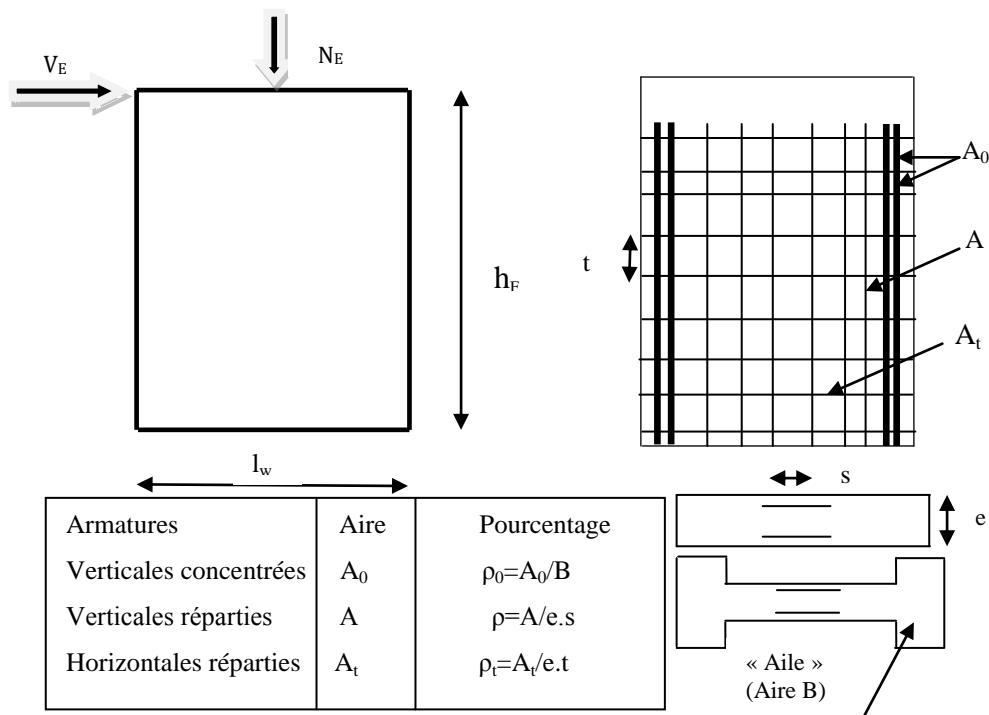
Schéma d'un voile plein et position du ferrailage
